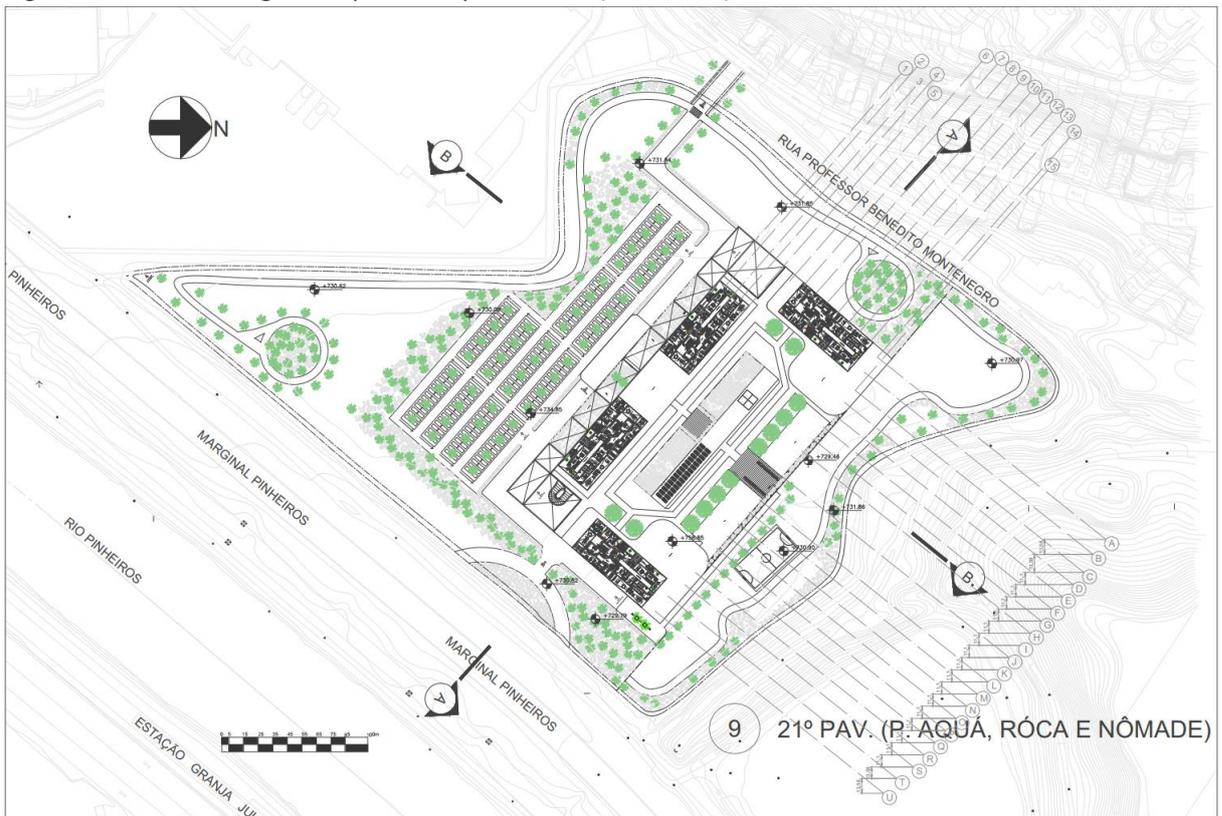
Planta vigésimo primeiro pavimento (mezanino) ampliada.
